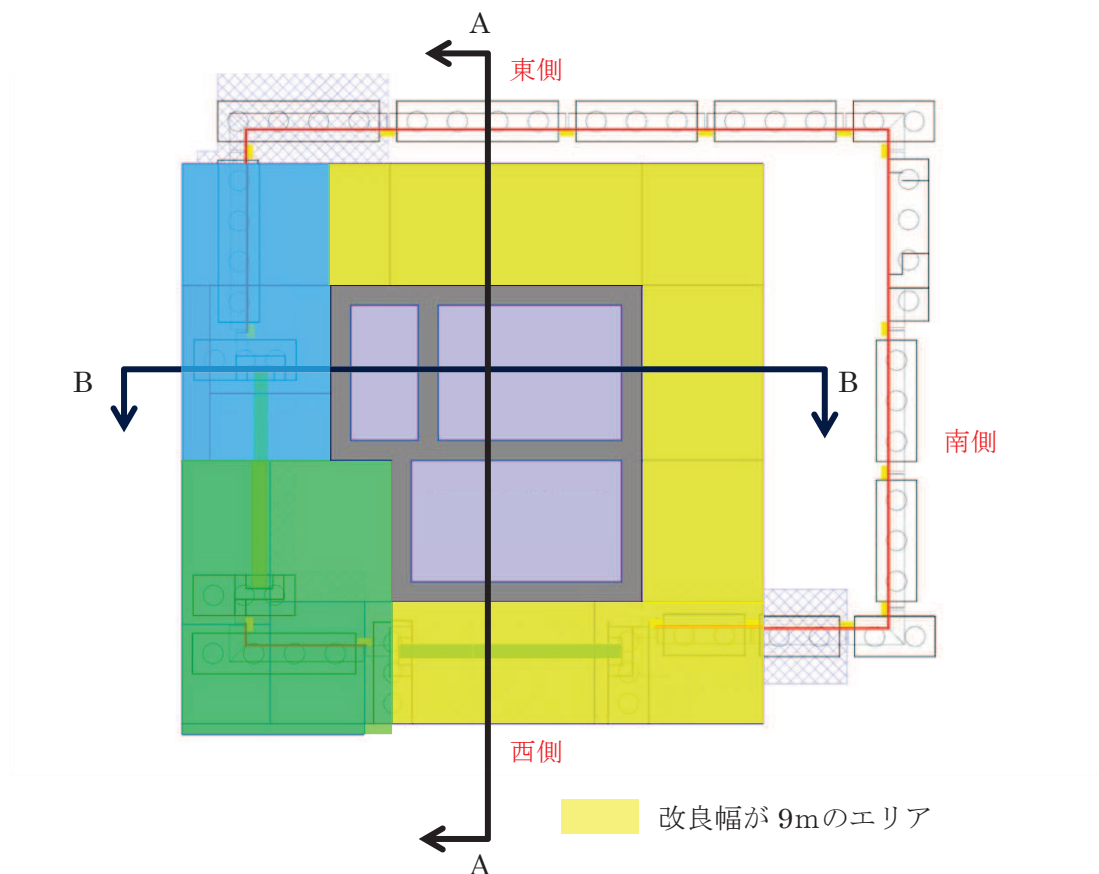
第 3 号機放水立坑評価対象断面 平面図
